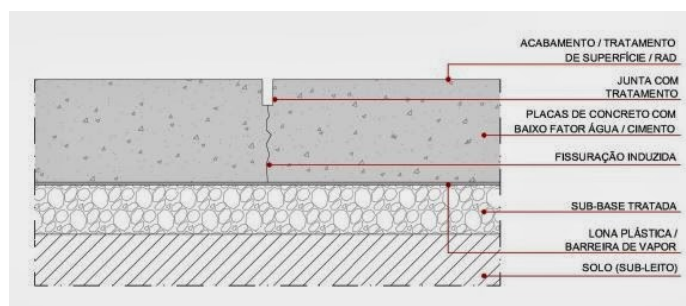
Seção de pavimento de concreto simples sem barra de transferência
